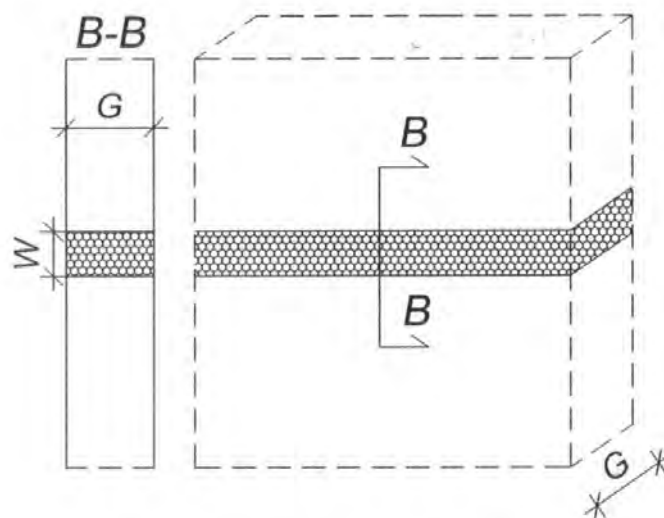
Proiezione e sezione del giunto lineare orizzontale nel muro
